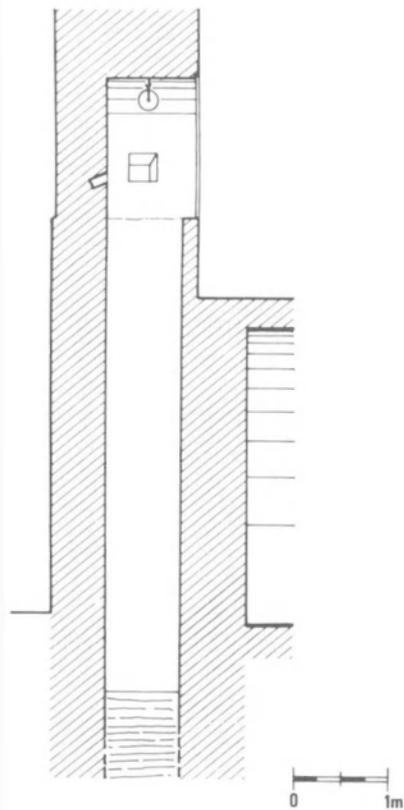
Spontin. Coupe transversale du puits du premier étage.
